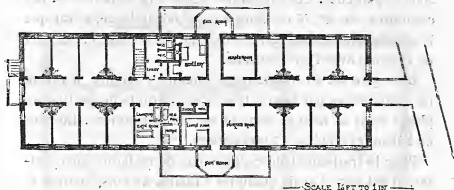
Salle d'isolement (échelle : 10 mètres pour 0^m,025).
